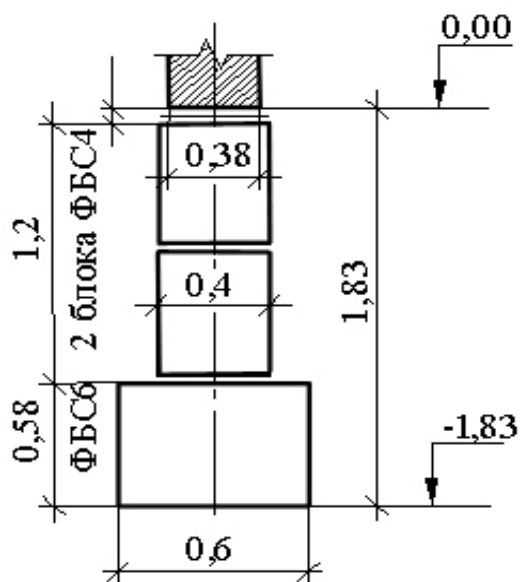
Сборный ленточный фундамент с подошвенной частью из стеновых блоков
